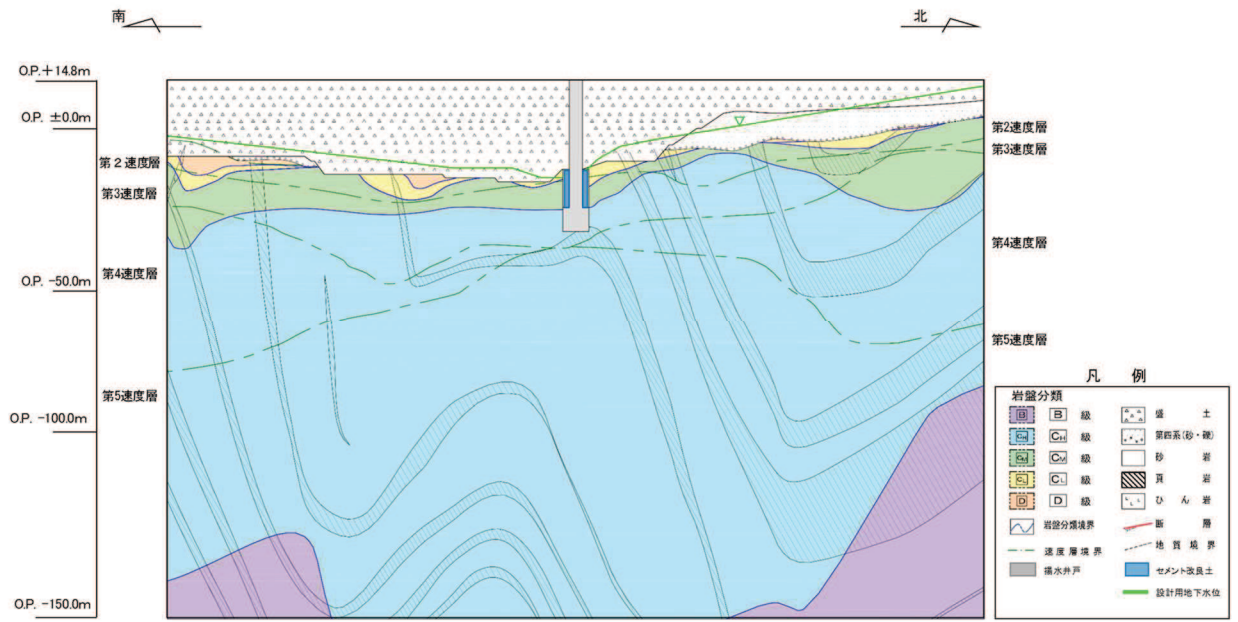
(3) No. 3 揚水井戸 評価対象断面図 (C' -C 断面)
